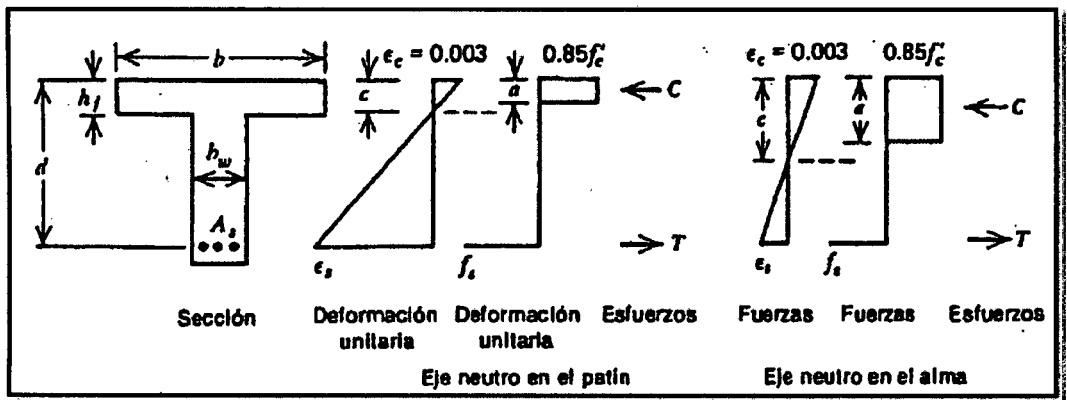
12: Viga T de concreto reforzado cuando se alcanza la resistencia a flexión (Park & Paulay, 1994).
